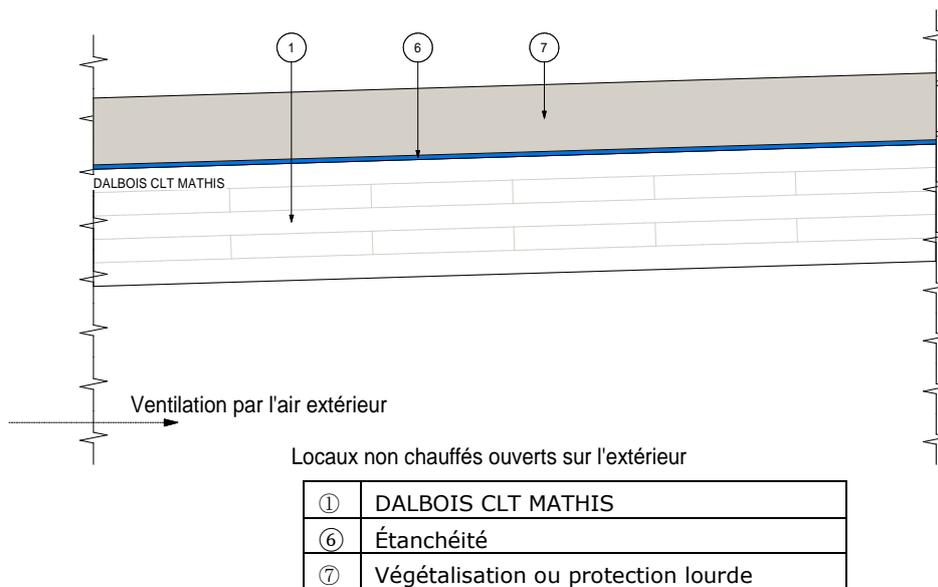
Utilisation d'un CLT DALBOIS CLT-M en configuration de toiture froide non isolée sur bâtiment non chauffé ouvert sur l'extérieur – Toiture inaccessible, technique et végétalisée
